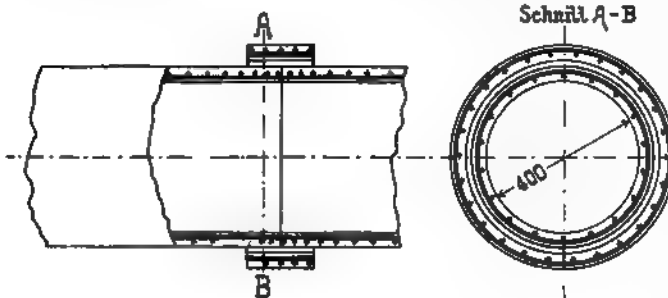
Eisenarmiertes Betonrohr, System Bordenave
